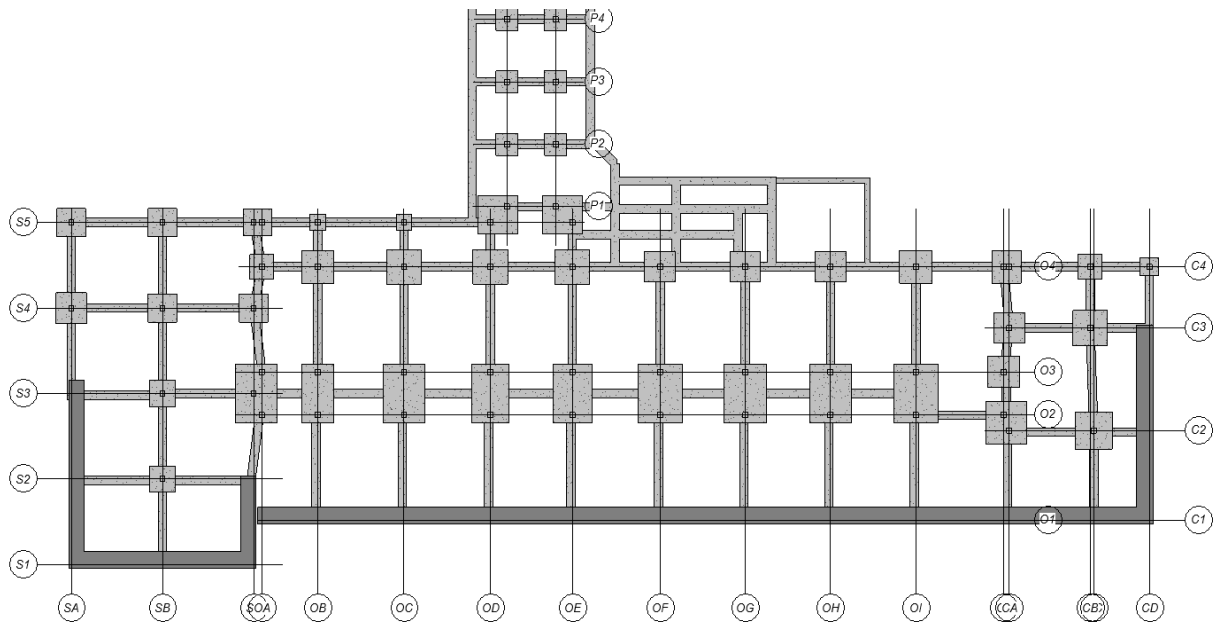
Vista en planta de la cimentación de la zona administrativa y salida al patio
